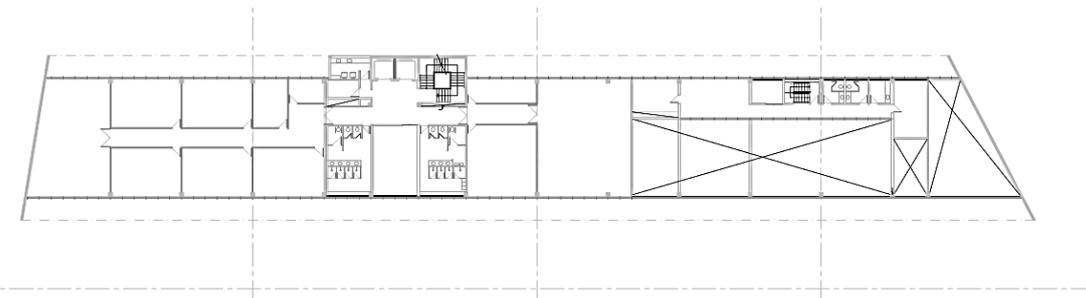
Bloco F, Planta do primeiro andar. Fonte: Arquivo da PGR.
